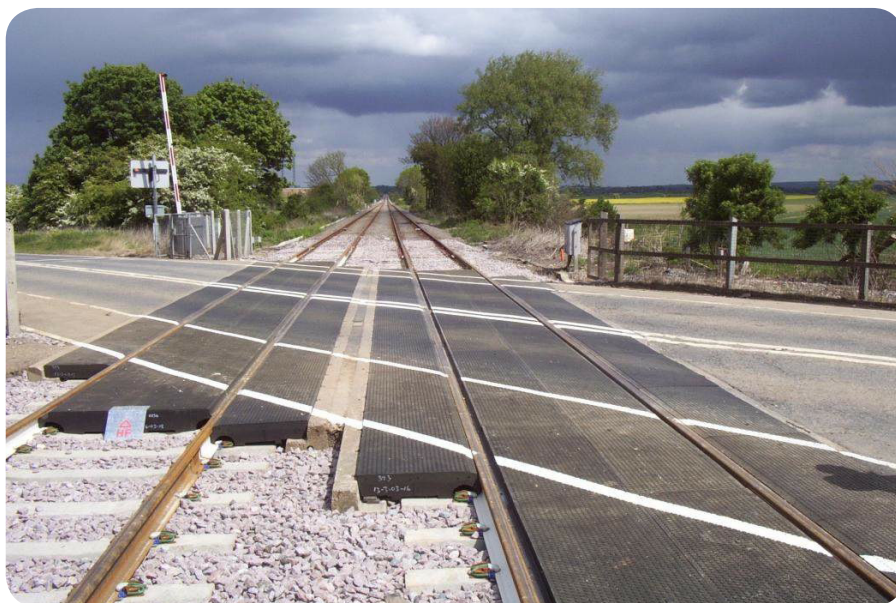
Pavimento de caucho antideslizante para Pasos a Nivel tipo HOLDFAST.
